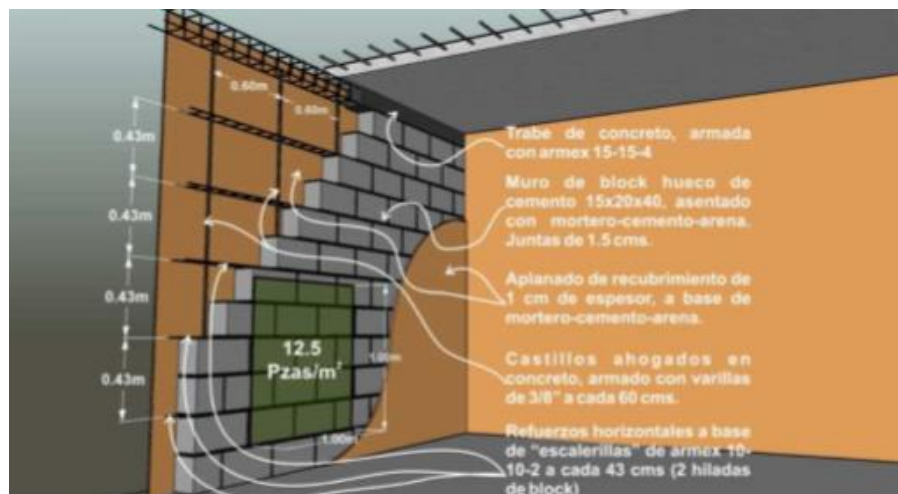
Representación de muro de block hueco (Gómez, 2010)
